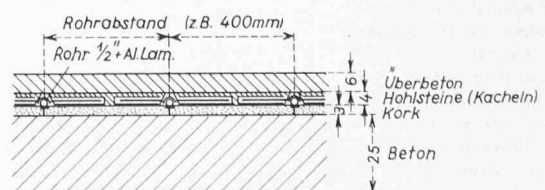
Querschnitt durch einen Betonboden mit in Hohlsteinen eingebauter Heizung, System Deriaz
